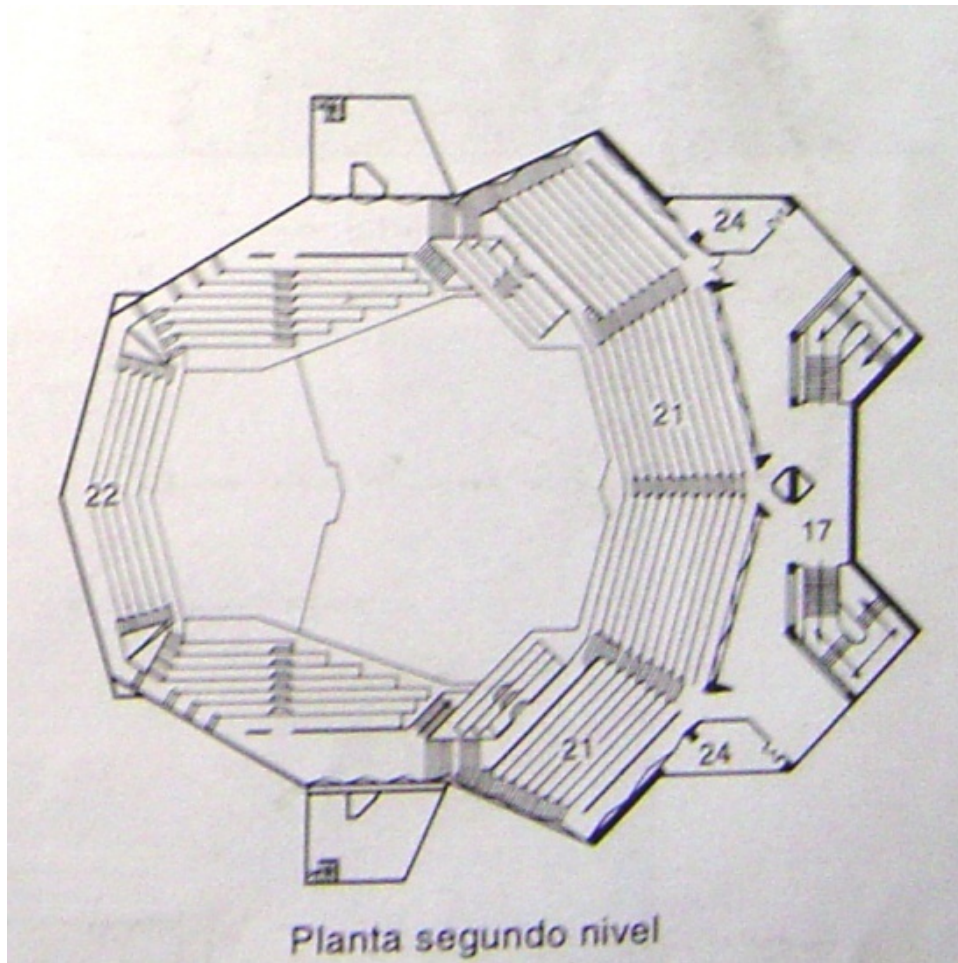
Planta arquitectónica la sala Nezahualcóyotl.
